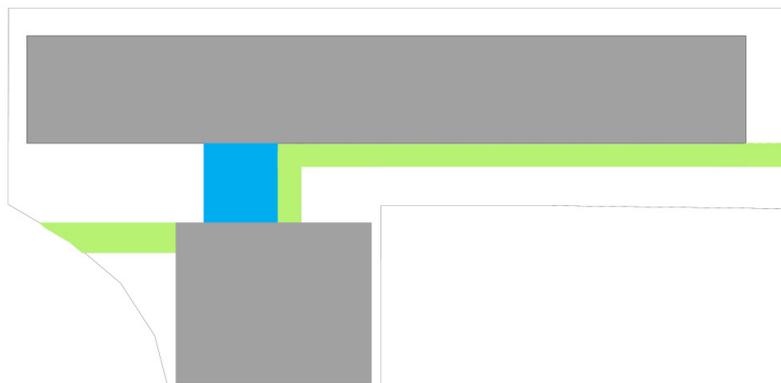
Planta con el patio central. (Elaboración Propia)
